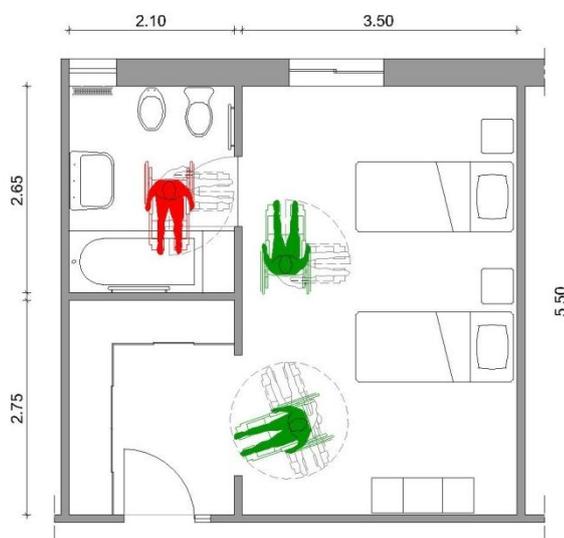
ILPI 1 - 2º pavimento - Planta baixa quarto e banheiro privado.
